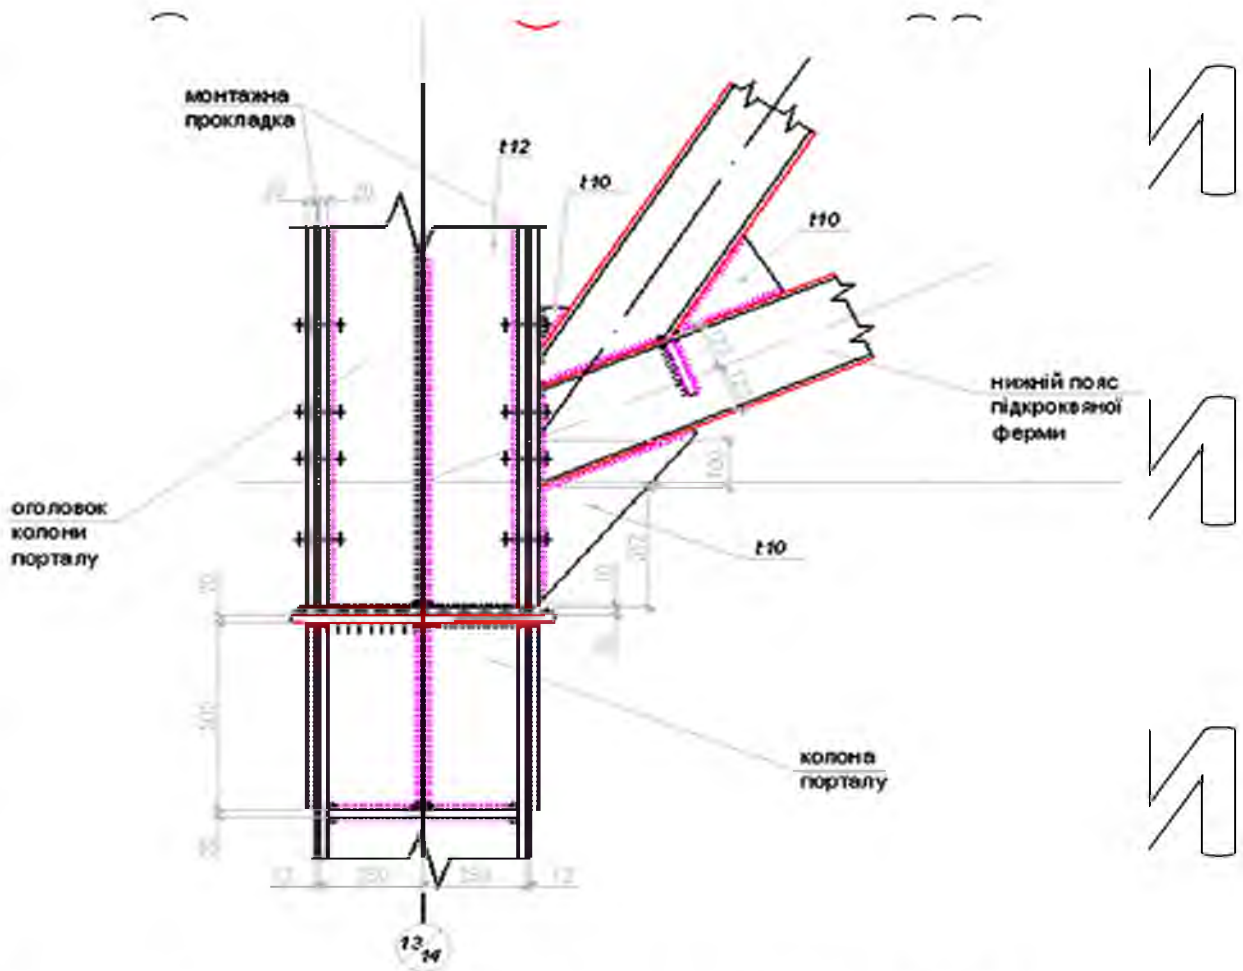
Вузол з'єднання підкресвяної ферми з колоною "порталу"
